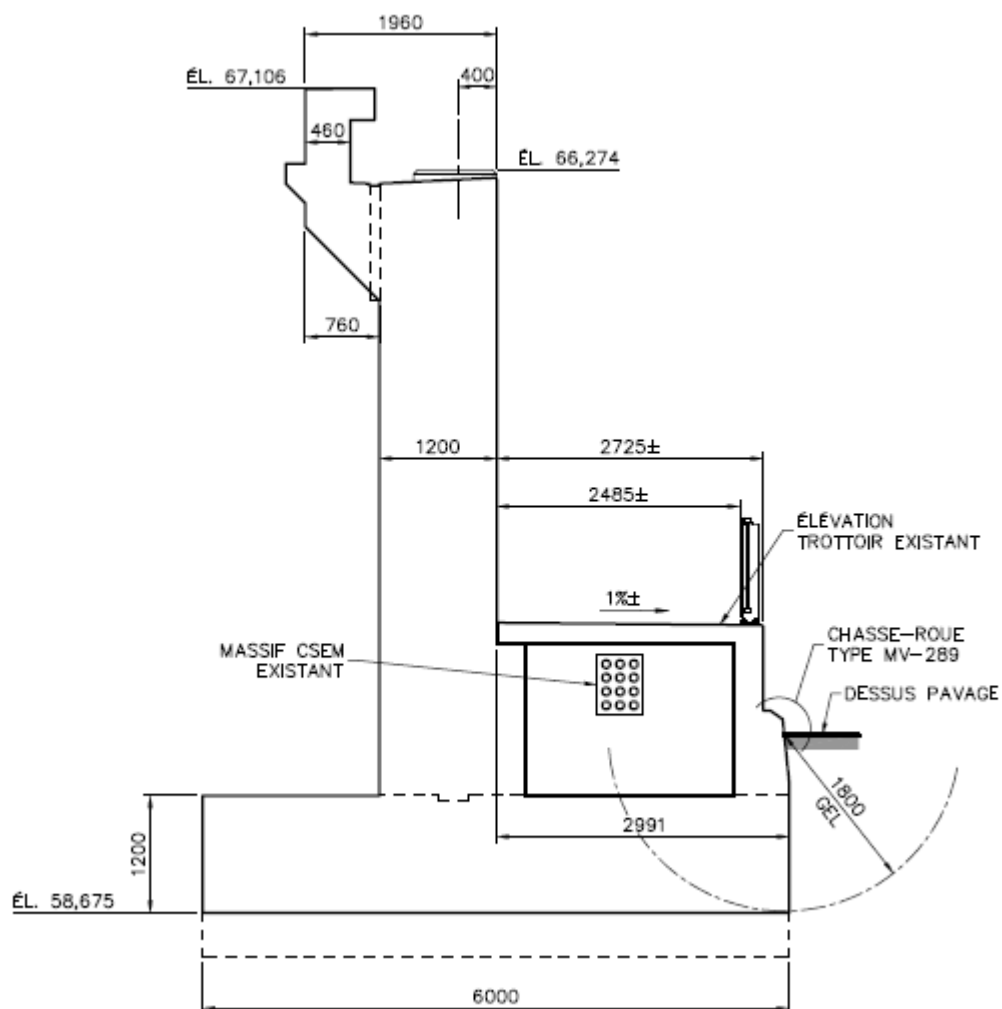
Pont d'étagement routier – Culée proposée axe 1 - Coupe type avec trottoir structural
